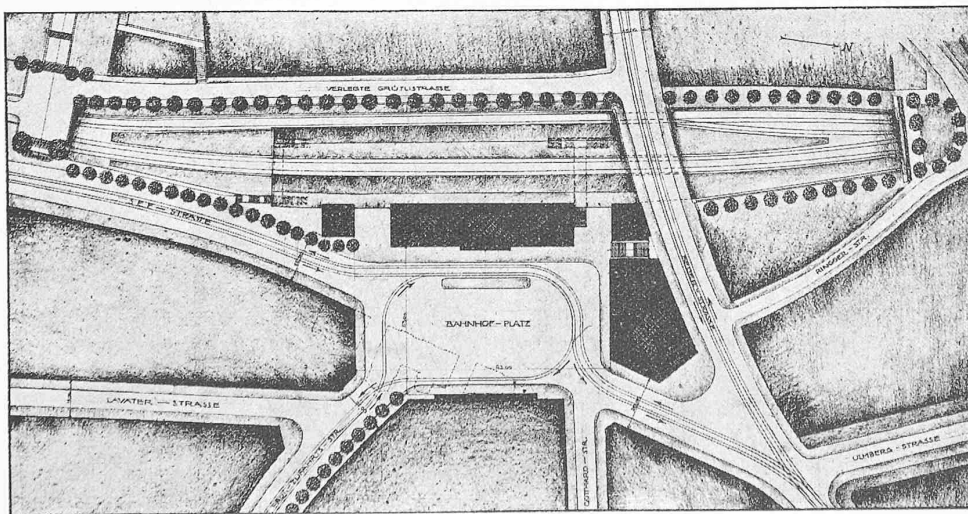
Entwurf Nr. 1. — Arch. Alb. Frölich, Zürich. — Lageplan Variante, Masstab 1 : 2500.
